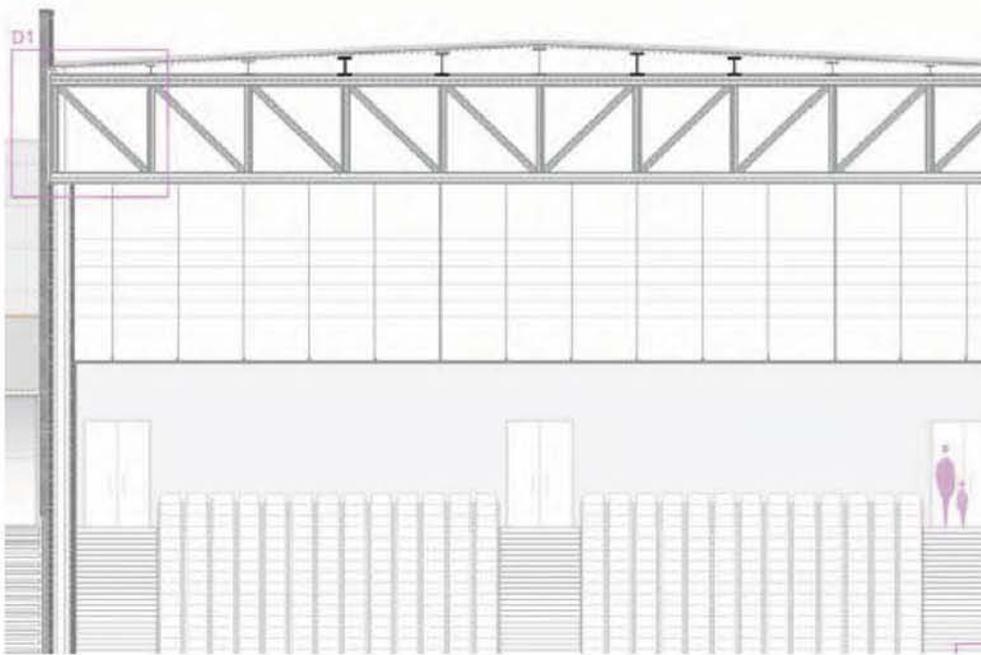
Último nivel de gradería, plafón acústico colgante sobre armadura apoyada en columnas de acero. Pendiente de la techumbre 2%.
